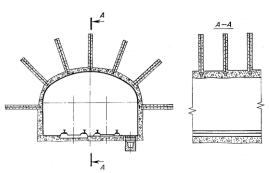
Комбіноване кріплення із набризкбетону та анкерів
